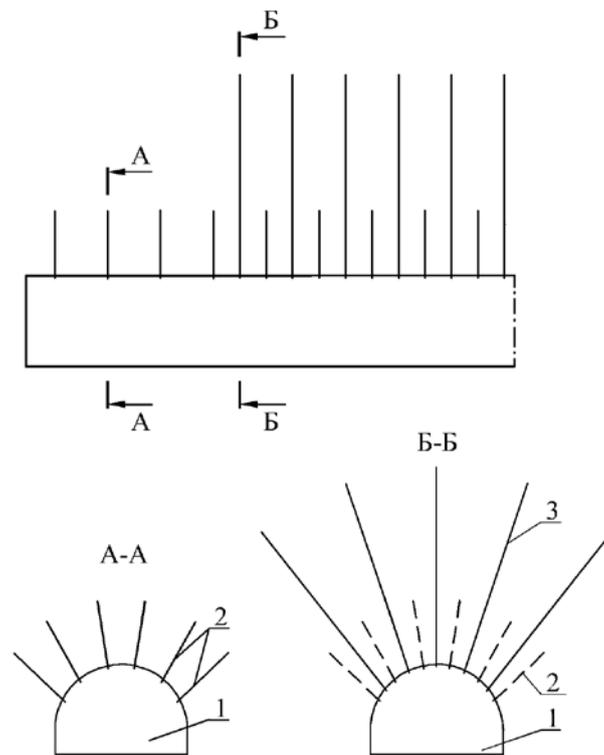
Схема комбинированного способа крепления выработки анкерной крепью: 1 – забой выработки; 2 – жесткая анкерная крепь; 3 – податливая анкерная крепь
